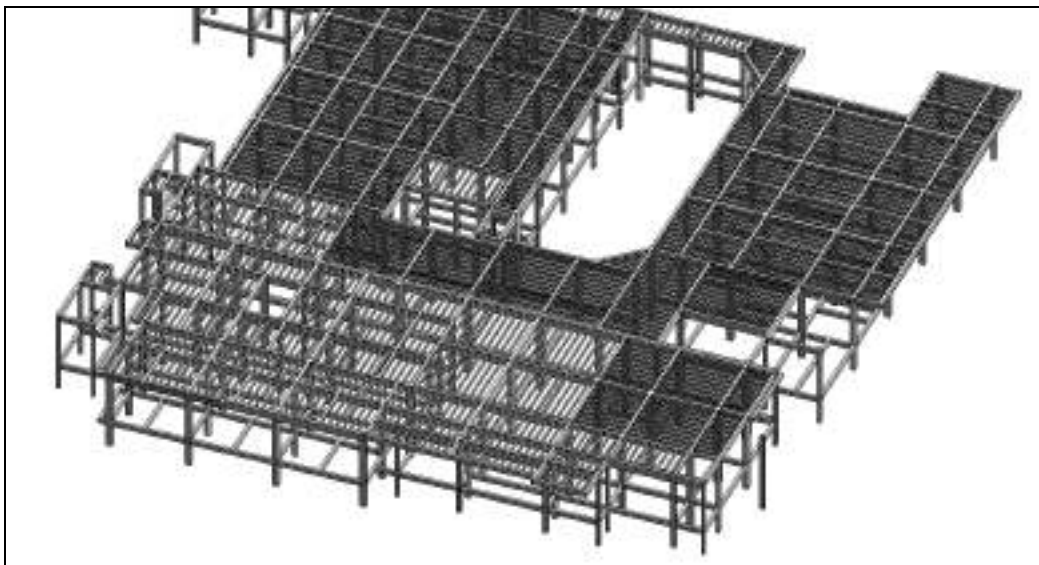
Revit -Vista 3D modelado de columnas y vigas (Primer piso)
